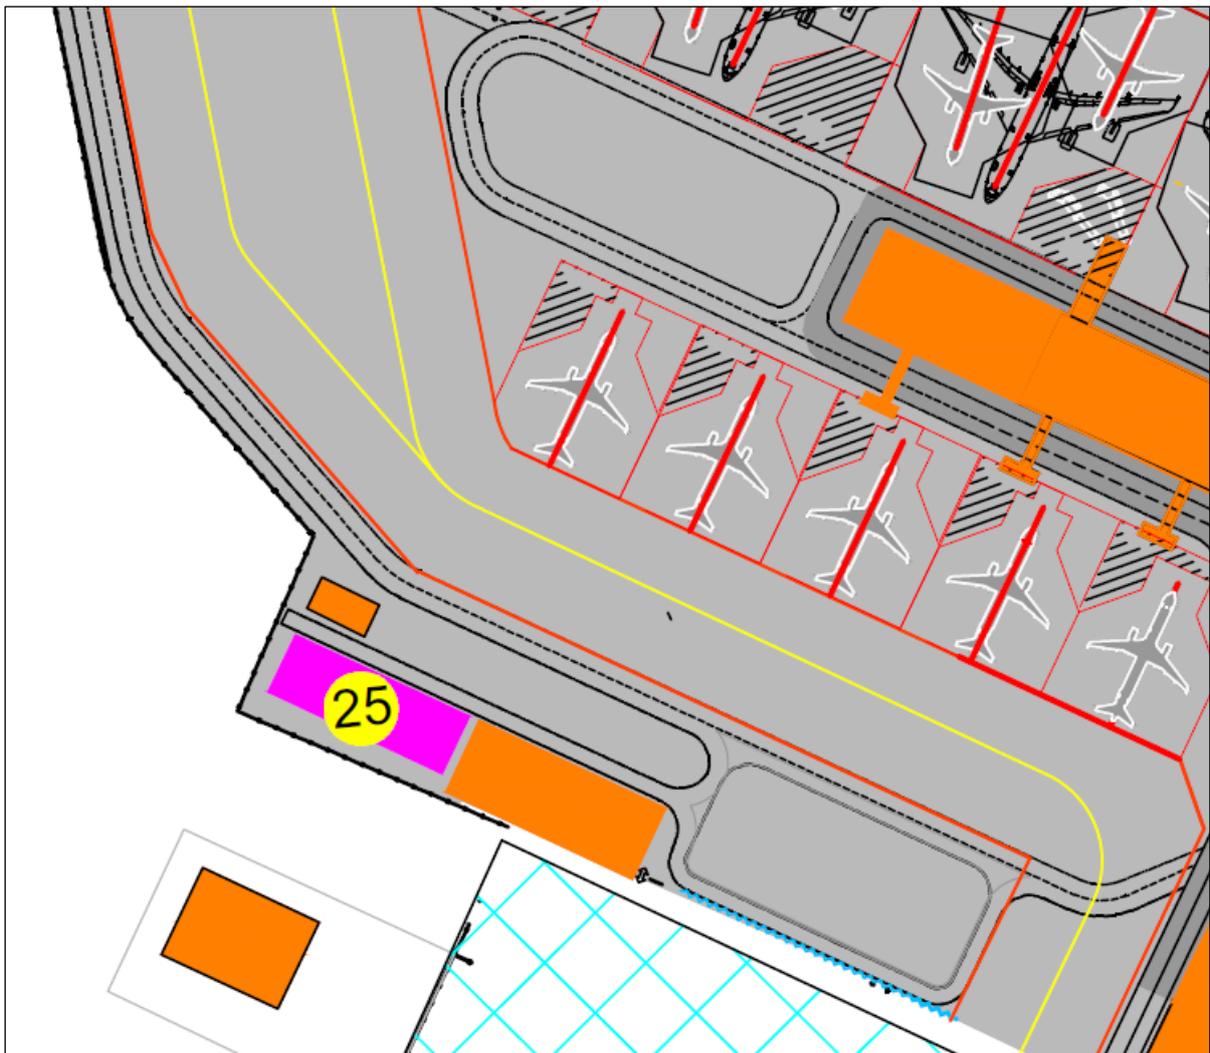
Estratto Master Plan – Nuovo Polo Tecnologico Ovest
